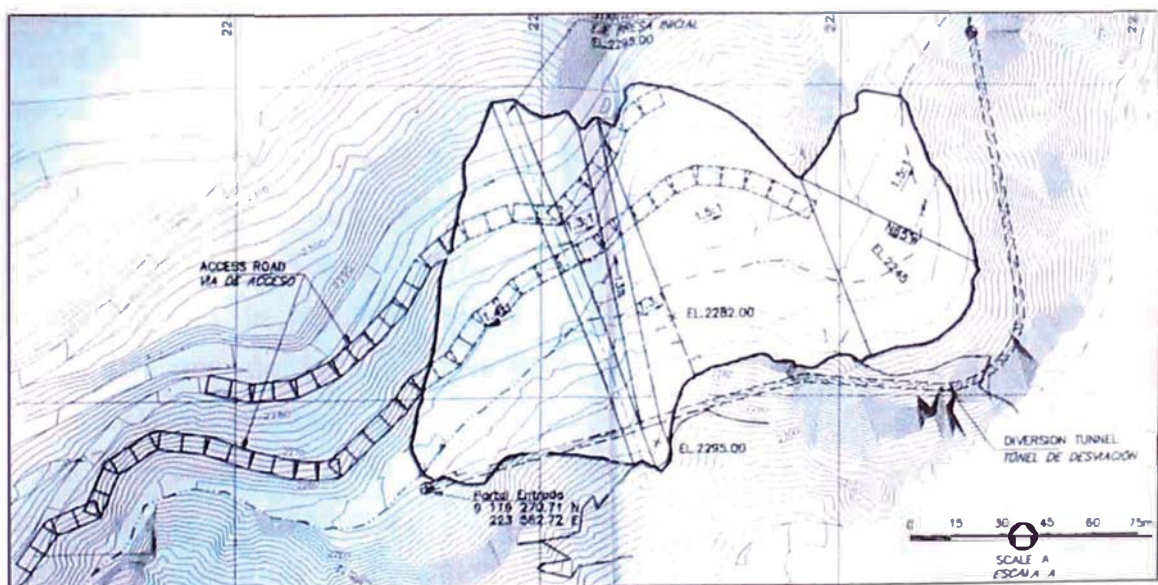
Se puede observar los accesos definidos para la alternativa de construcción N° 2.
